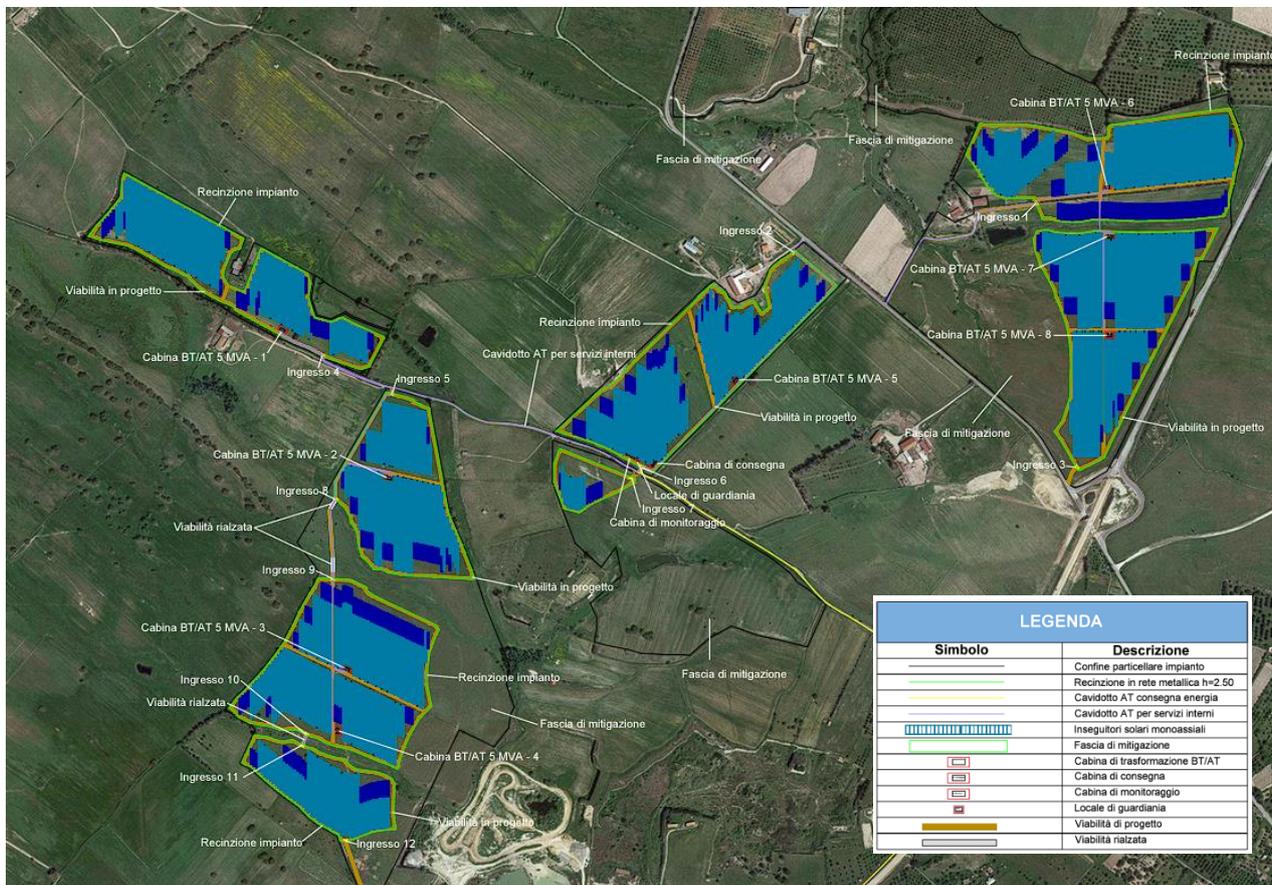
LAYOUT PLANIMETRICO DELL'AREA D'IMPIANTO
